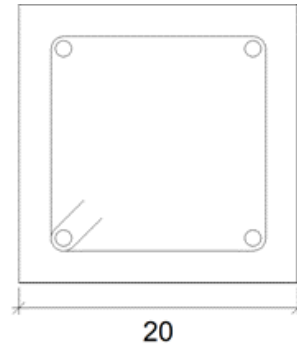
Sección transversal columna más solicitada (fuente: elaboración propia).
